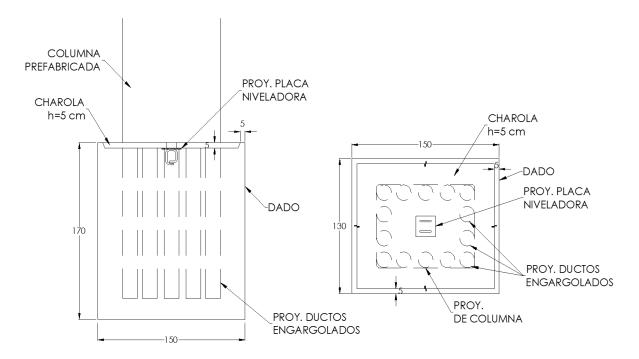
Preparación en cimentación para la fabricación del dado de conexión con la columna. Proyecto Centro Integral de Servicios Puebla.
